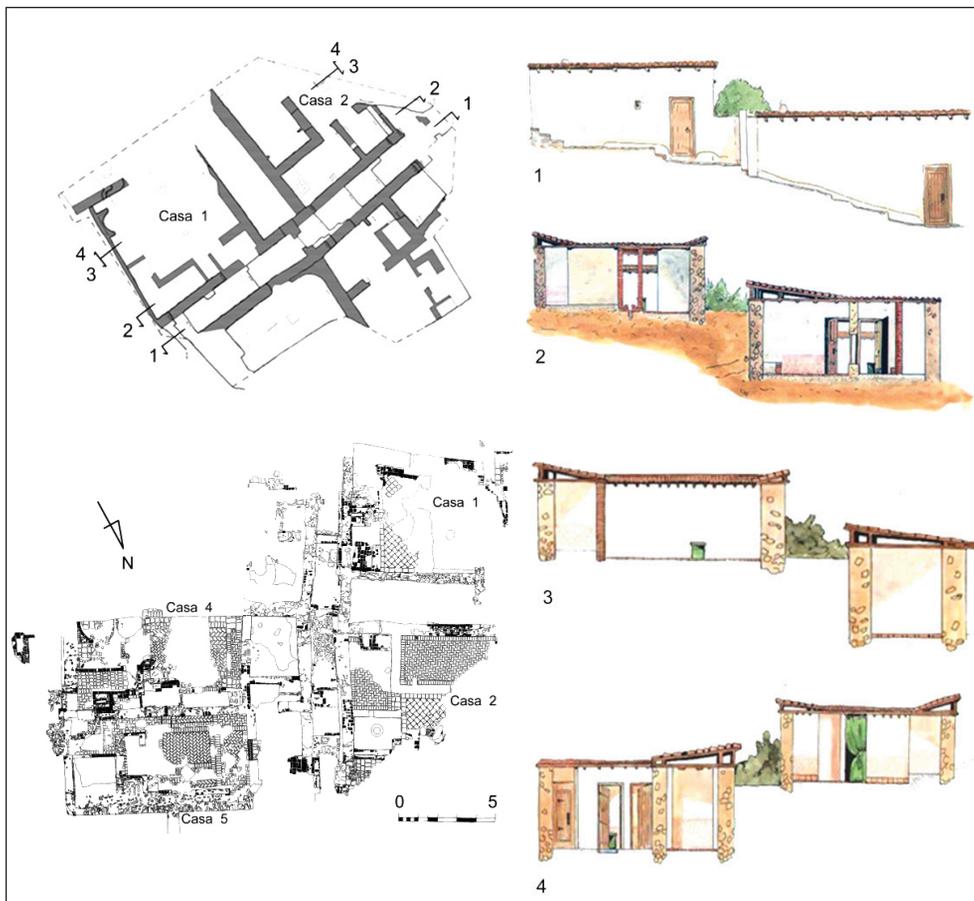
Planta y secciones de viviendas de Huerta Rufino.
